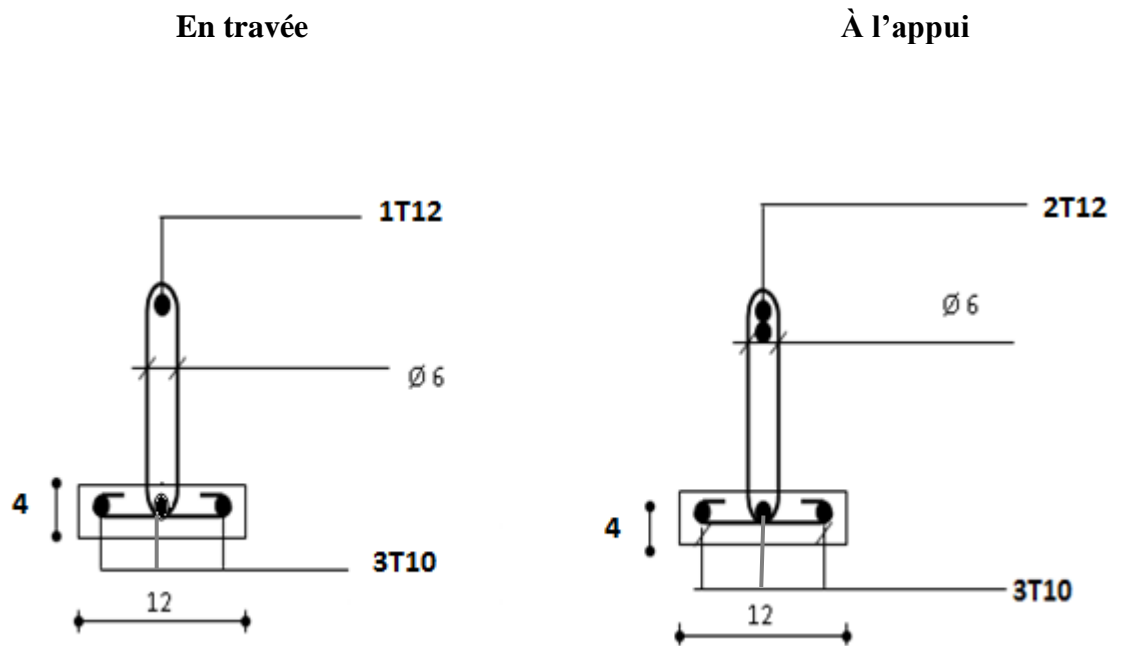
Ferrailage des poutrelles sur les différents étages courants
